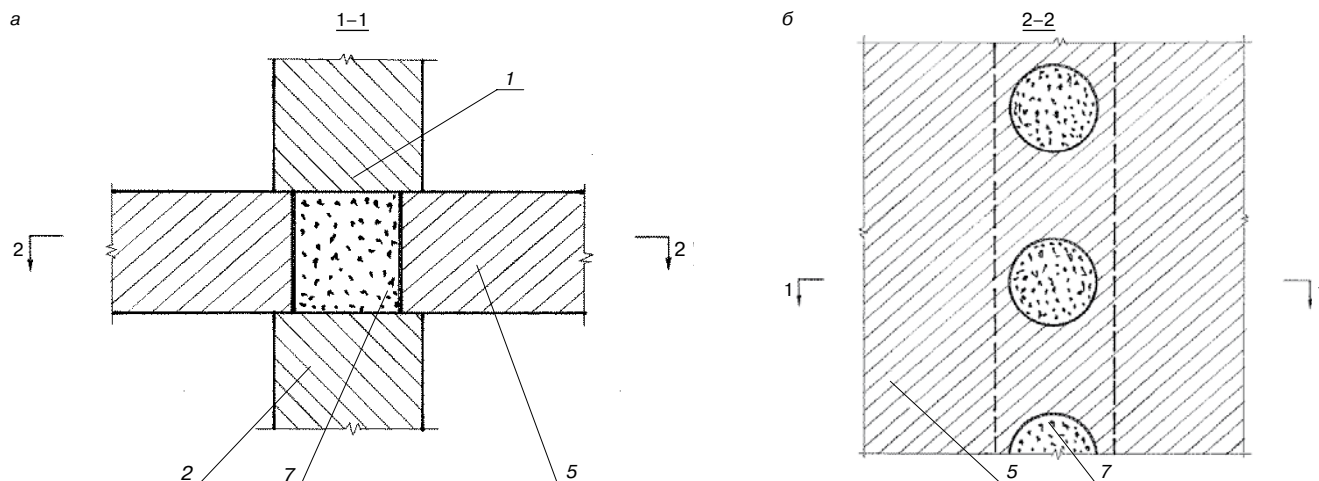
Платформенный стык с трубобетонными элементами в здании с монолитными стенами из тяжелого бетона и перекрытиями из легкого бетона: а – поперечное сечение 1–1; б – продольное сечение 2–2
